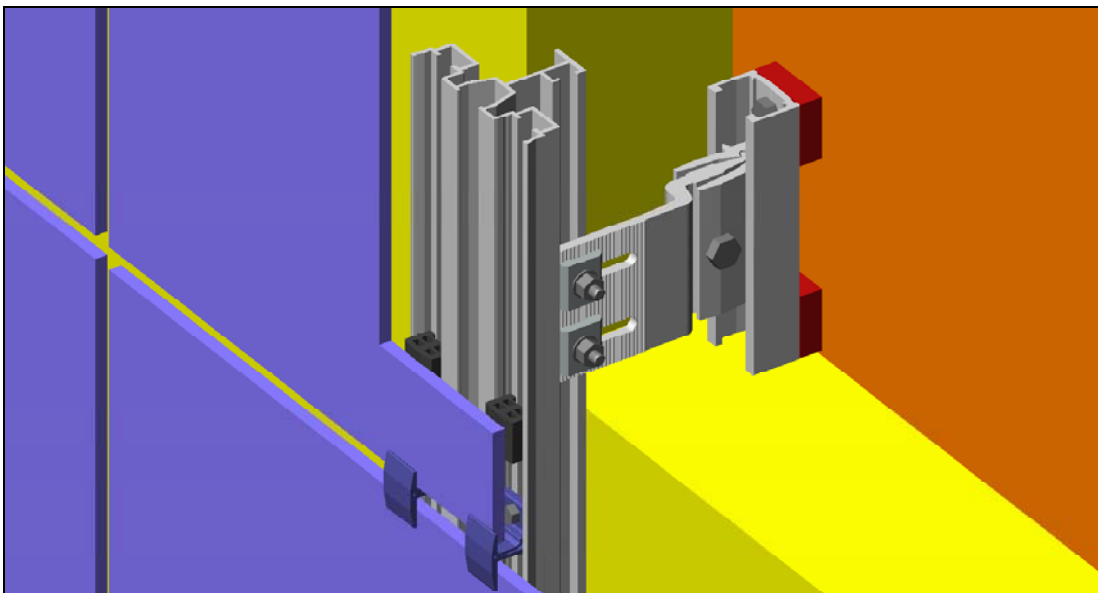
ALUHIT-P- Befestigungssystem bei Verankerung auf einer Betonwand oder Mauerwerk
